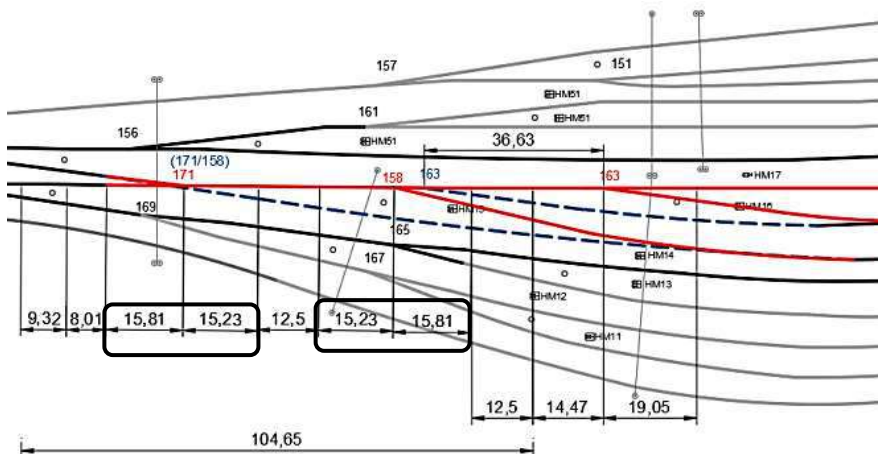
Схема смещения стрелочного перевода № 163 после укладки стрелочных переводов № 171 и № 158 взамен перекрестного
